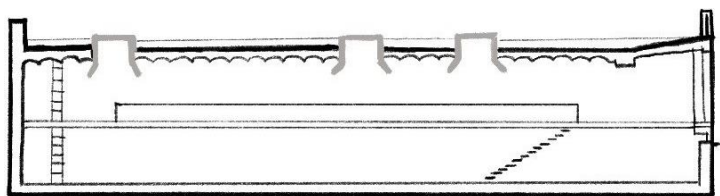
Разрез угольного бункера в Барселоне после реконструкции
